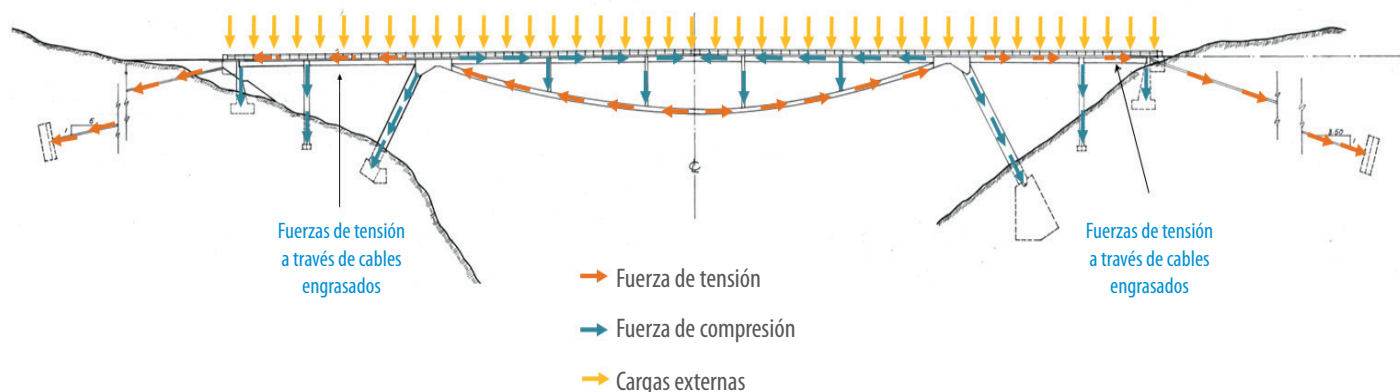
Esquema de la ruta de carga estructural que soportan los elementos del puente sobre el río Colorado. (Esquema modificado en Vargas-Alas, 2017 de los planos del Ministerio de Transportes, 1968)
